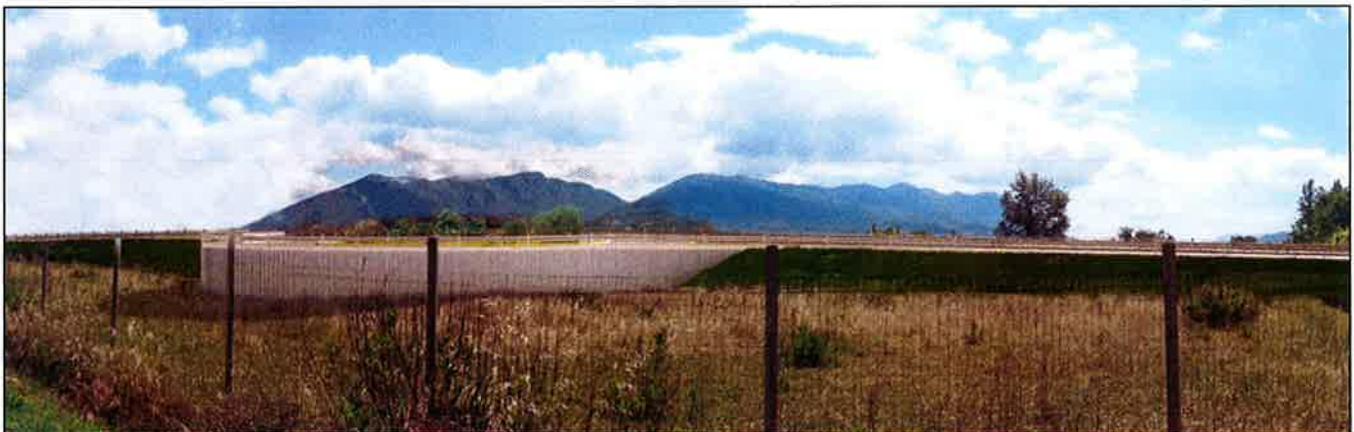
Foto dal punto di vista individuato per il fotoinserimento: situazione post-operam
